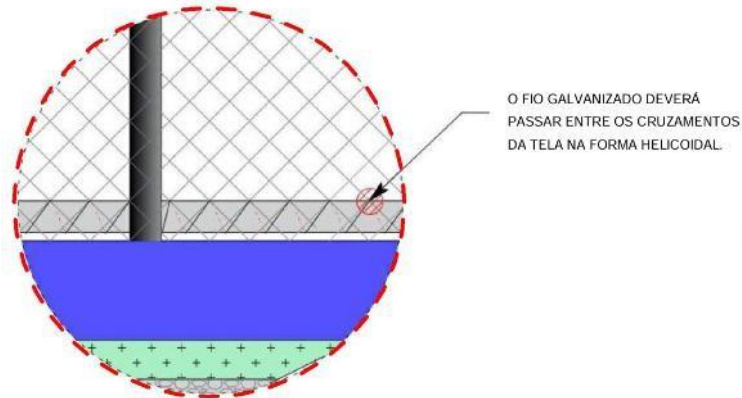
Detalhe da fixação das telas (Fonte: Autor/2025)
